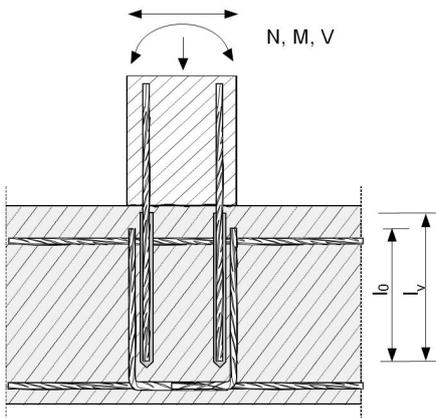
Übergreifungsstoß mit bestehender Bewehrung einer biegebeanspruchten Stütze oder Wand an ein Fundament. Die Bewehrungsstäbe sind zugbeansprucht.
